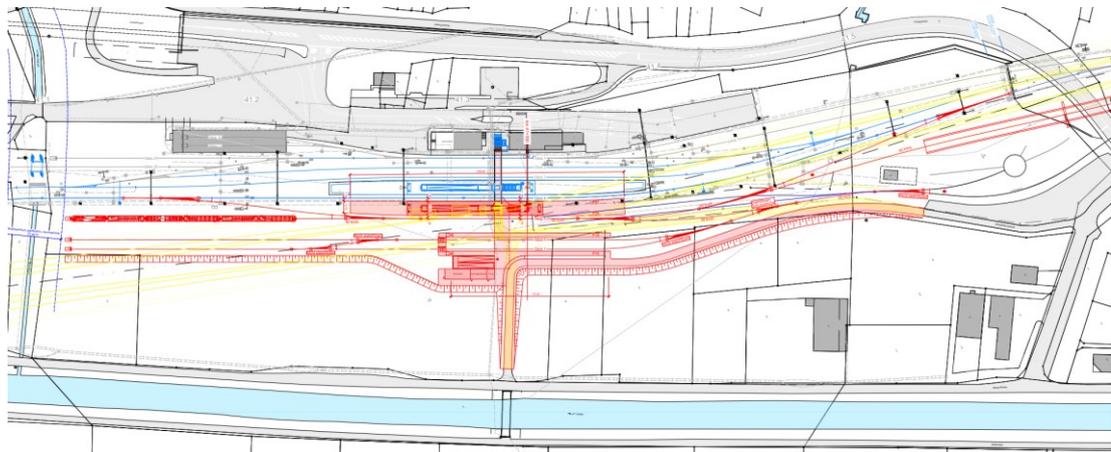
Situation Bahnhof Oberwald (Plan E+B aus Beilage D10)
